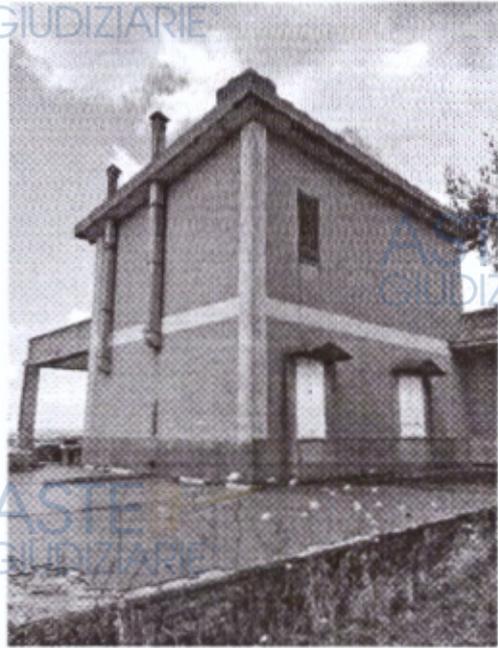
e 2 – Fabbricato oggetto di accatastamento
